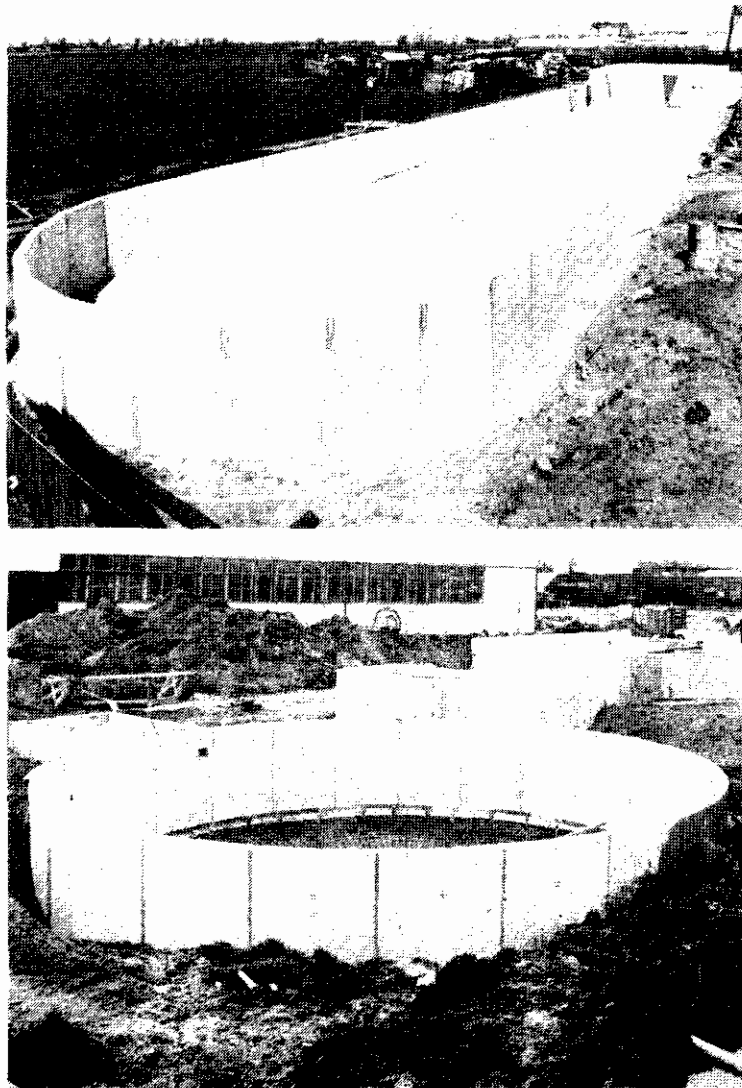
Carrousel en nabezinktank van de zuiveringsinrichting voor wasserij Nooitgedacht
